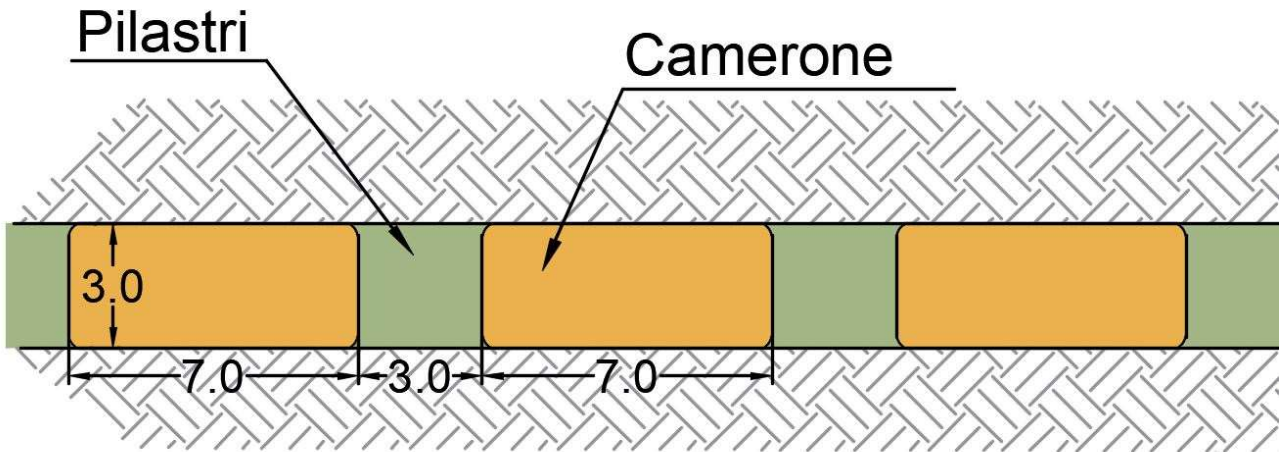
Particolare della sezione di giacimento con coltivazione R&P
